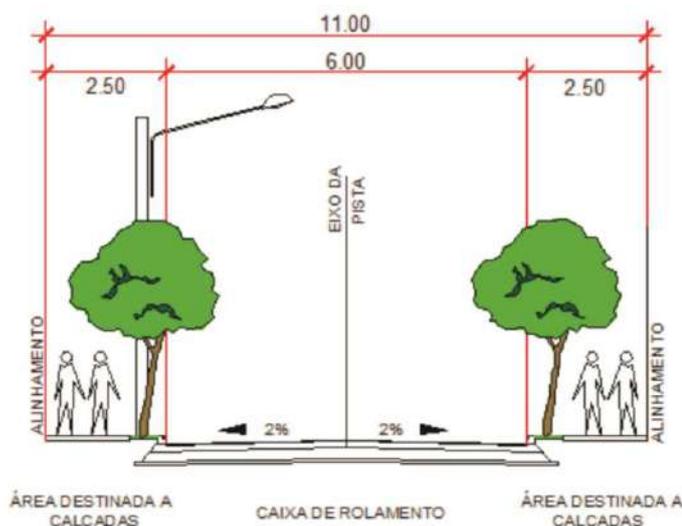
Perfil transversal padrão das Vias de Circulação Interna do Condomínio
